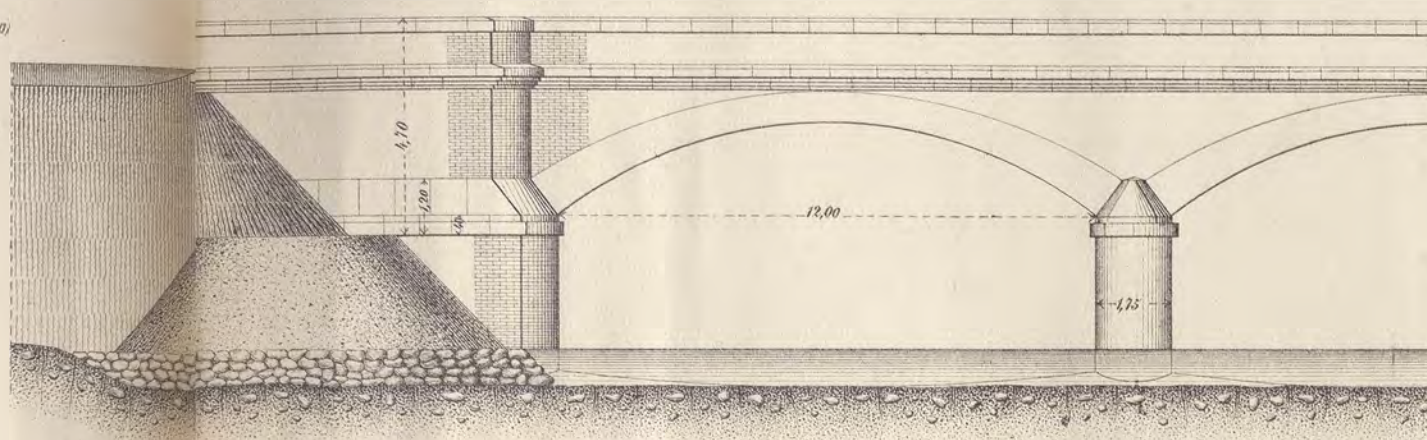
<sup>a</sup> Elevazione a valle di una pila-spalla.
